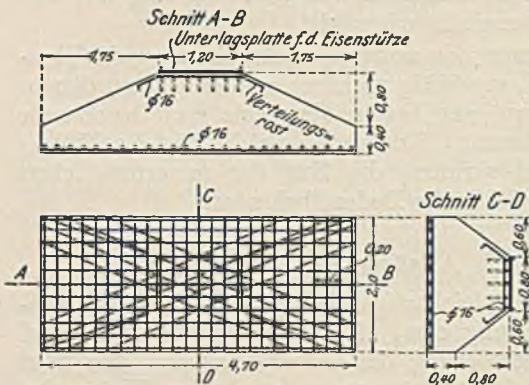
a bis c. Anordnung einer vollen Eisenbetonplatte.
